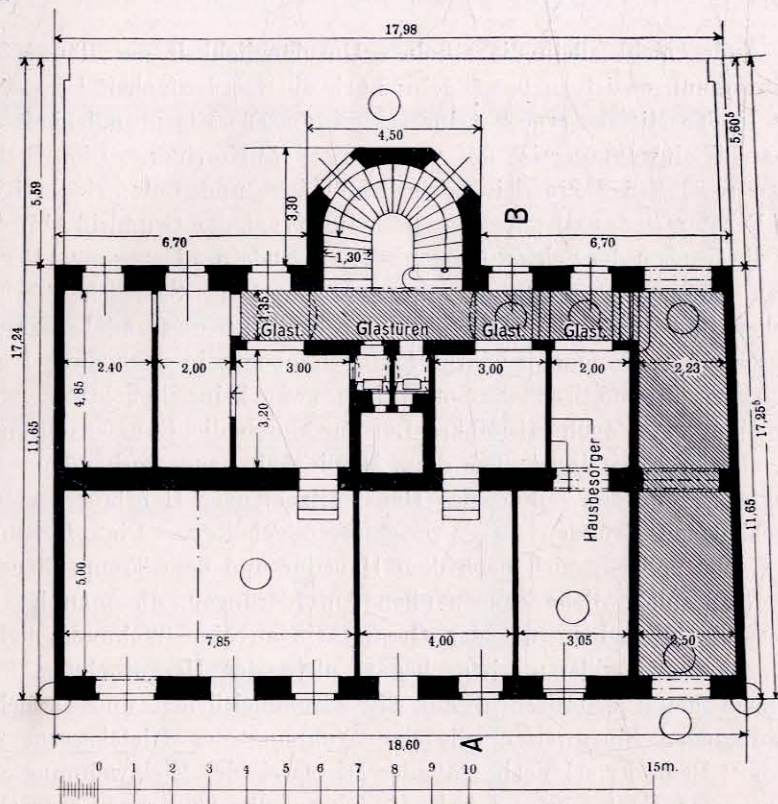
Neues Wohngebäude, Mittelbaustelle, Wien. Erdgeschoß.
